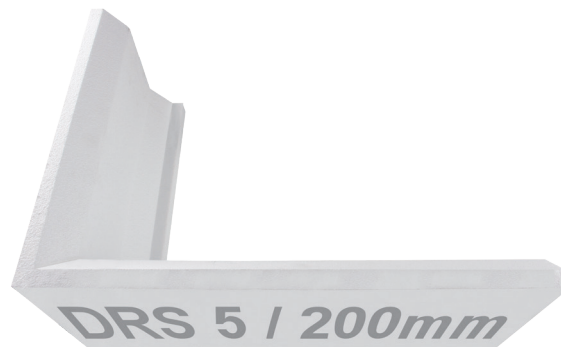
Ausführung Eckdetail Deckenrandschalung
